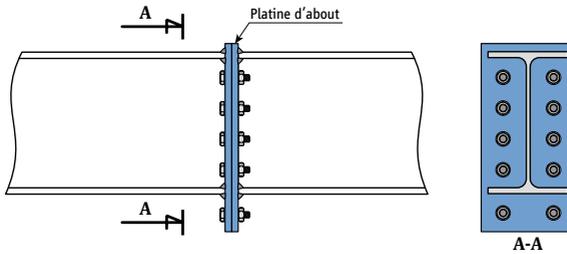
Assemblage de continuité par platine d'about débordante non raidie
